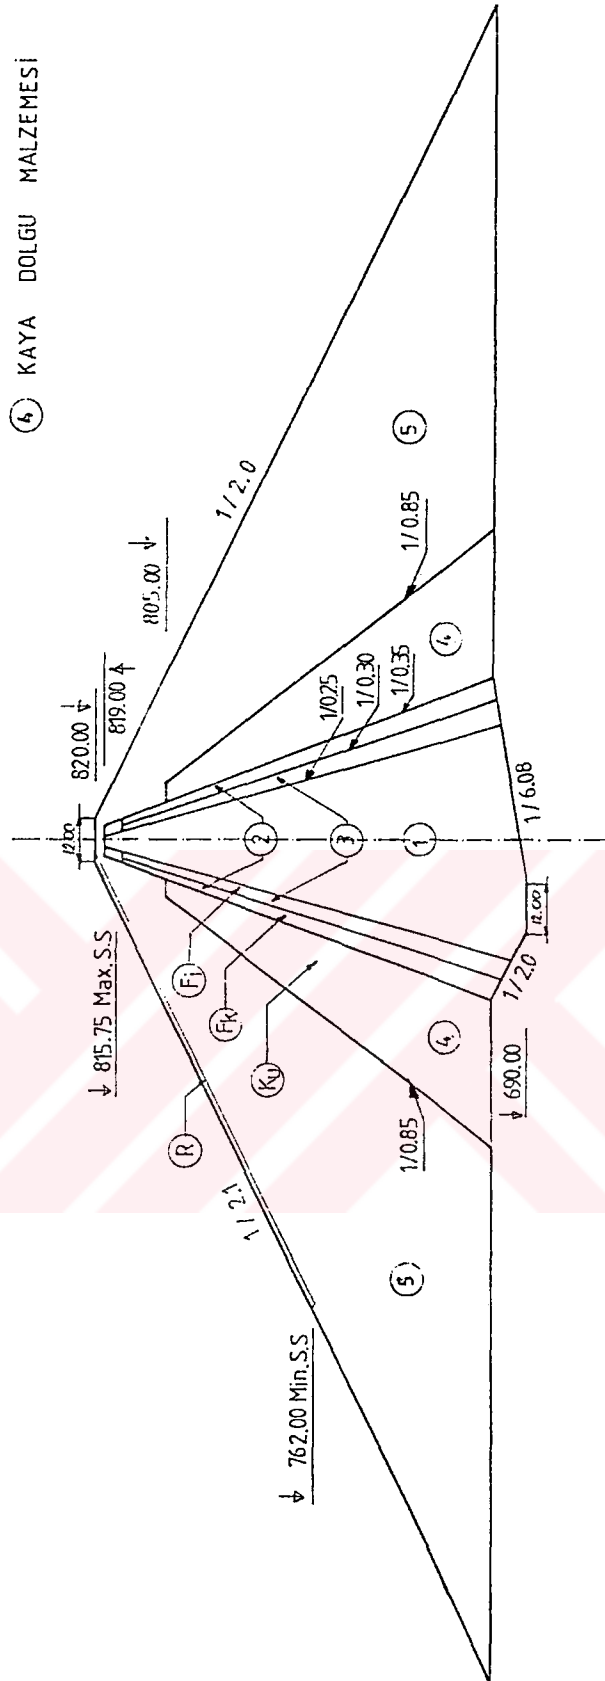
Kıralkızı Barajı Genel Vaziyet Planı.
